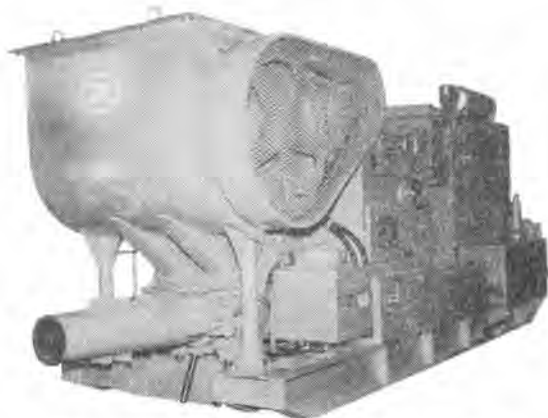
コンクリートポンプ（最大骨材径 80 mm 用）
